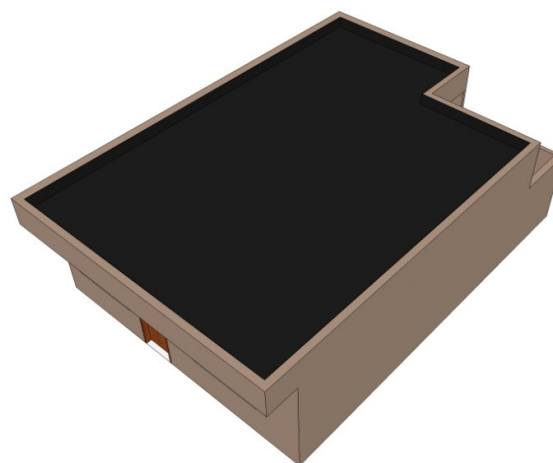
Laje de concreto pré-moldado com lajota cerâmica.
